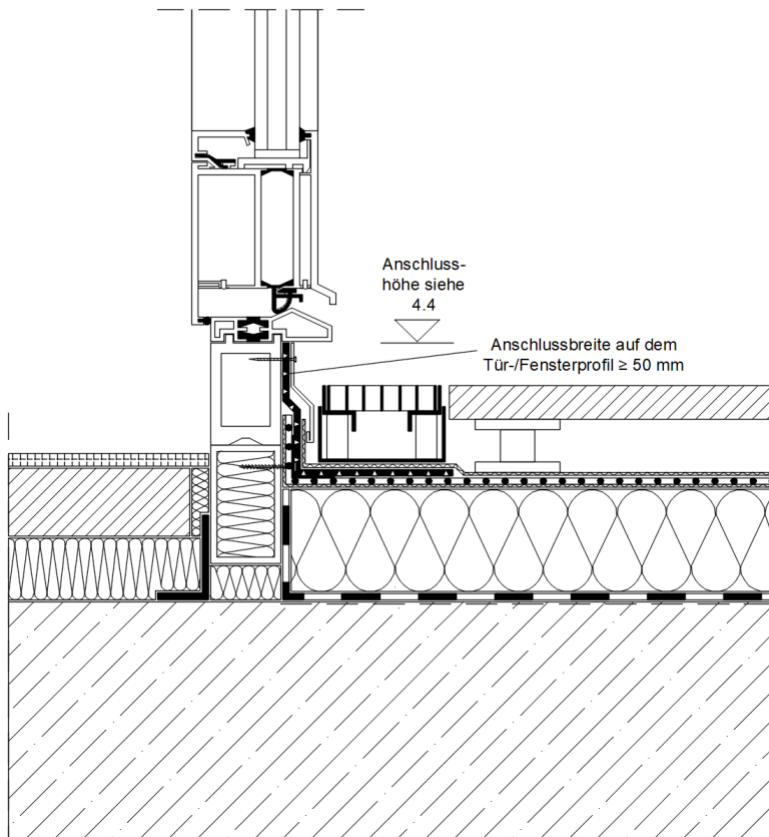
Terrassentüranschluss mit Entwässerungsrinne – Ausführung mit Kunststoffbahnen und Flüssigkunststoff mit systemintegrierter Nuttschicht – Anschlusshöhe  $\geq 5$  cm (durchgehende Deckenplatte)
